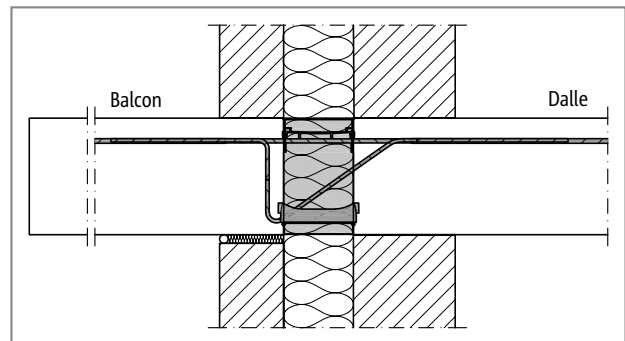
Schöck Isokorb® T Type K : Raccordement sur maçonnerie à double coque et isolation du noyau
